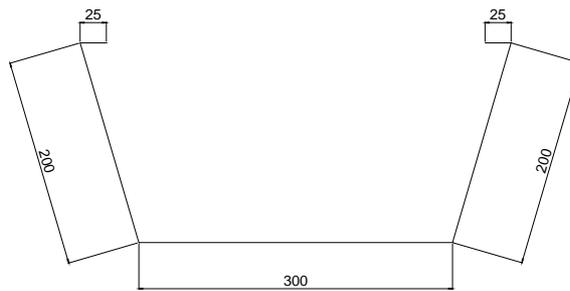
Chéneau encastré (épaisseur 1 mm)
